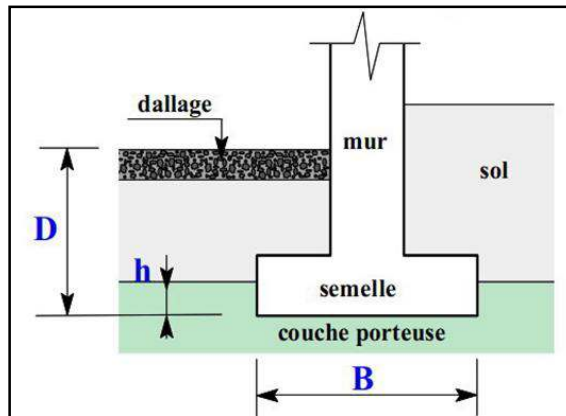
Coupe verticale d'une semelle superficielle [2]
